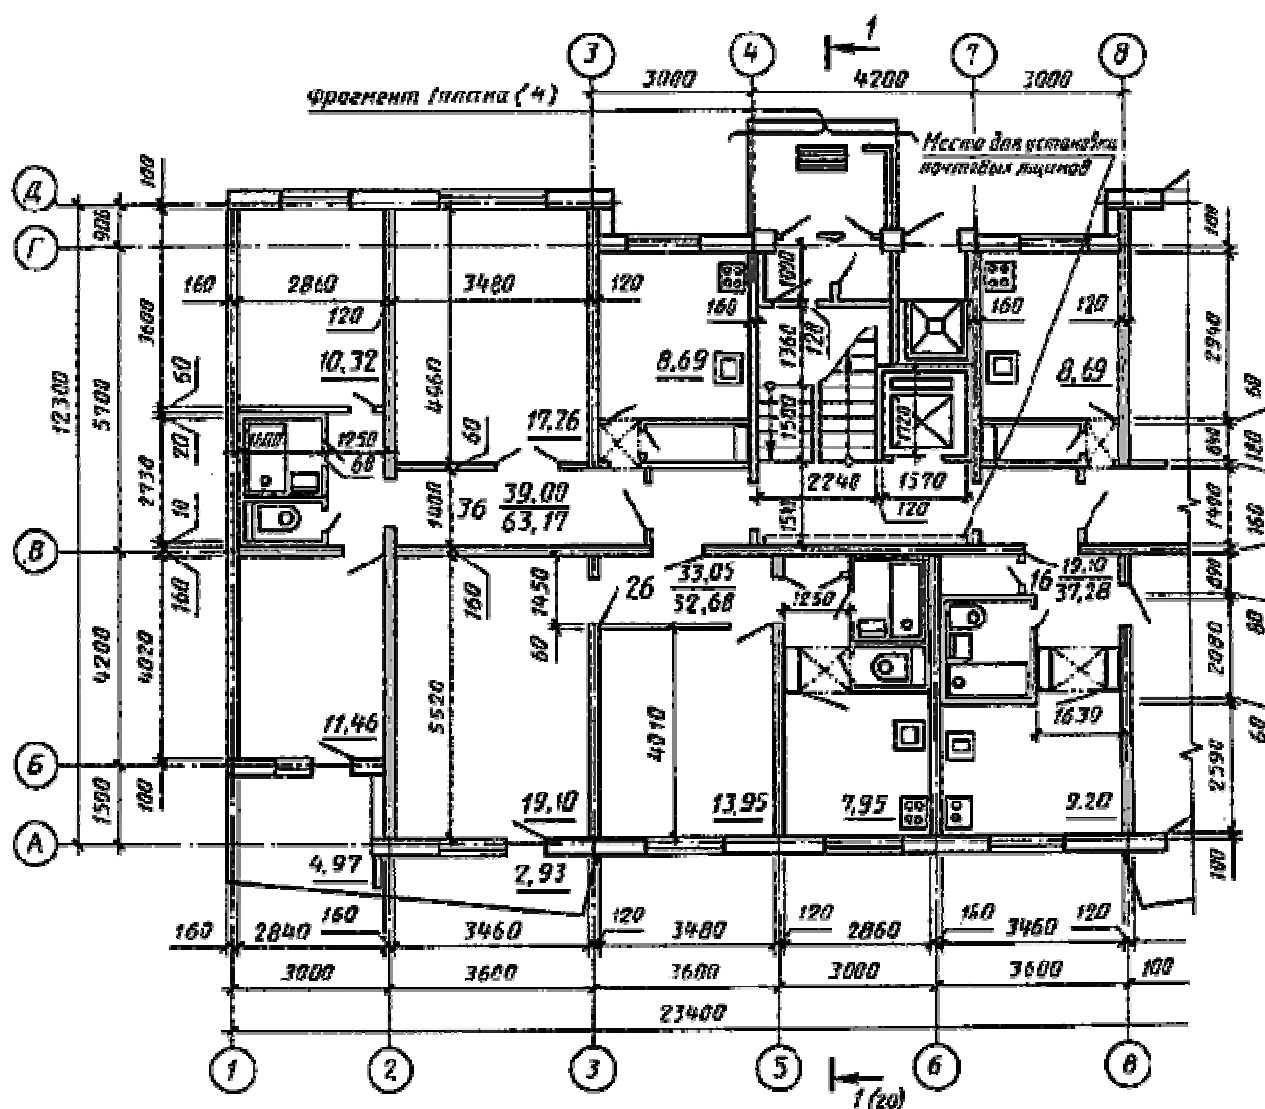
Пример выполнения плана этажа жилого дома
